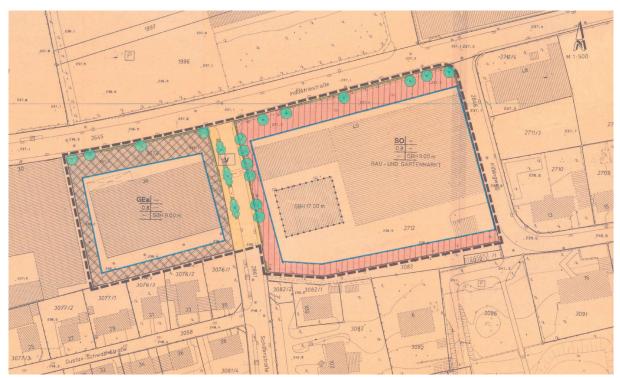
Ausschnitt Bebauungsplan "Baumarkt Industriestraße – 1. Änderung und Ergänzung", rechtsverbindlich seit dem 14.02.1998
